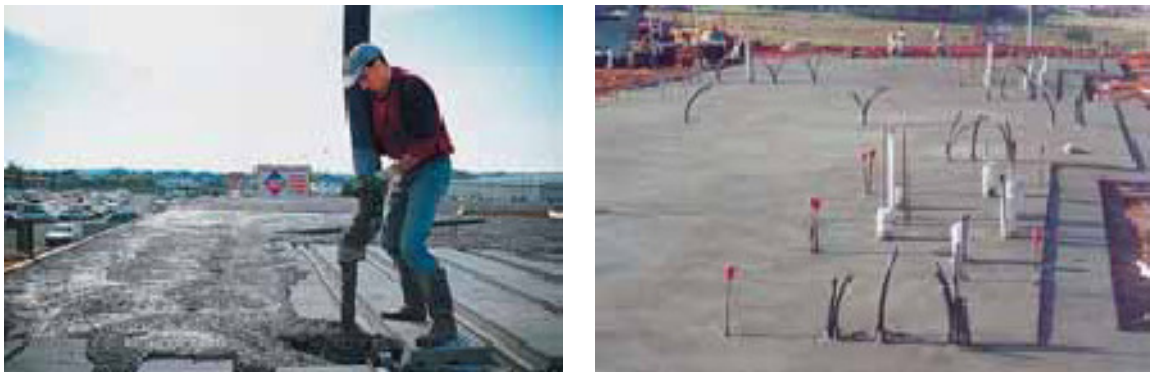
Capa de Compressão e radier executado com concreto com fibras (DRAMIX, 2009).
